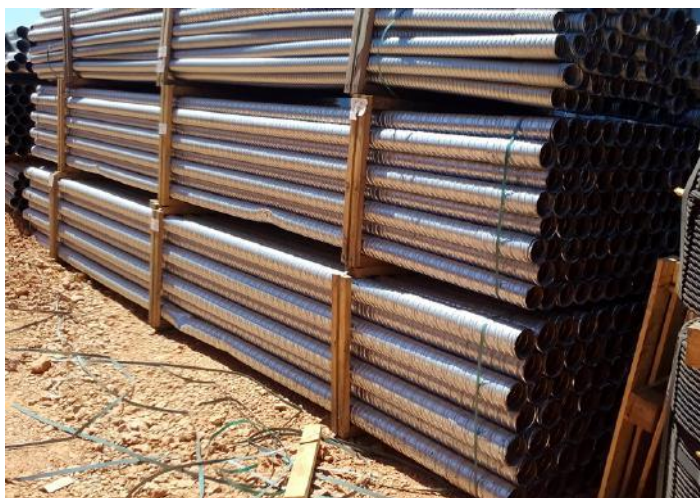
Acomodação das bainhas metálicas em estaleiro
